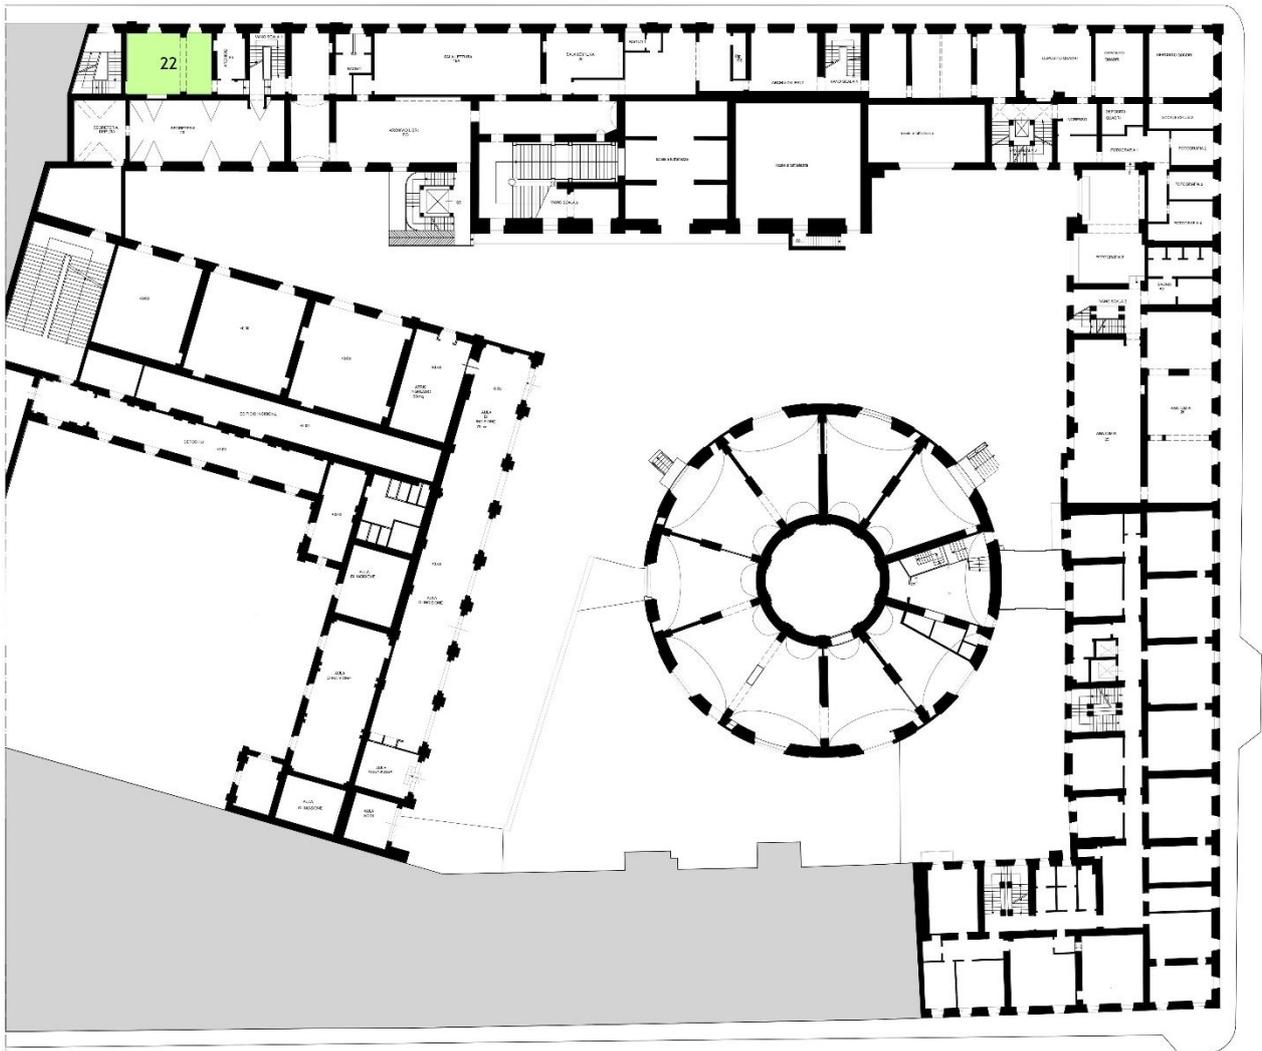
Pianta dello stato di fatto con indicazione dei locali riservati agli studenti, primo piano.
